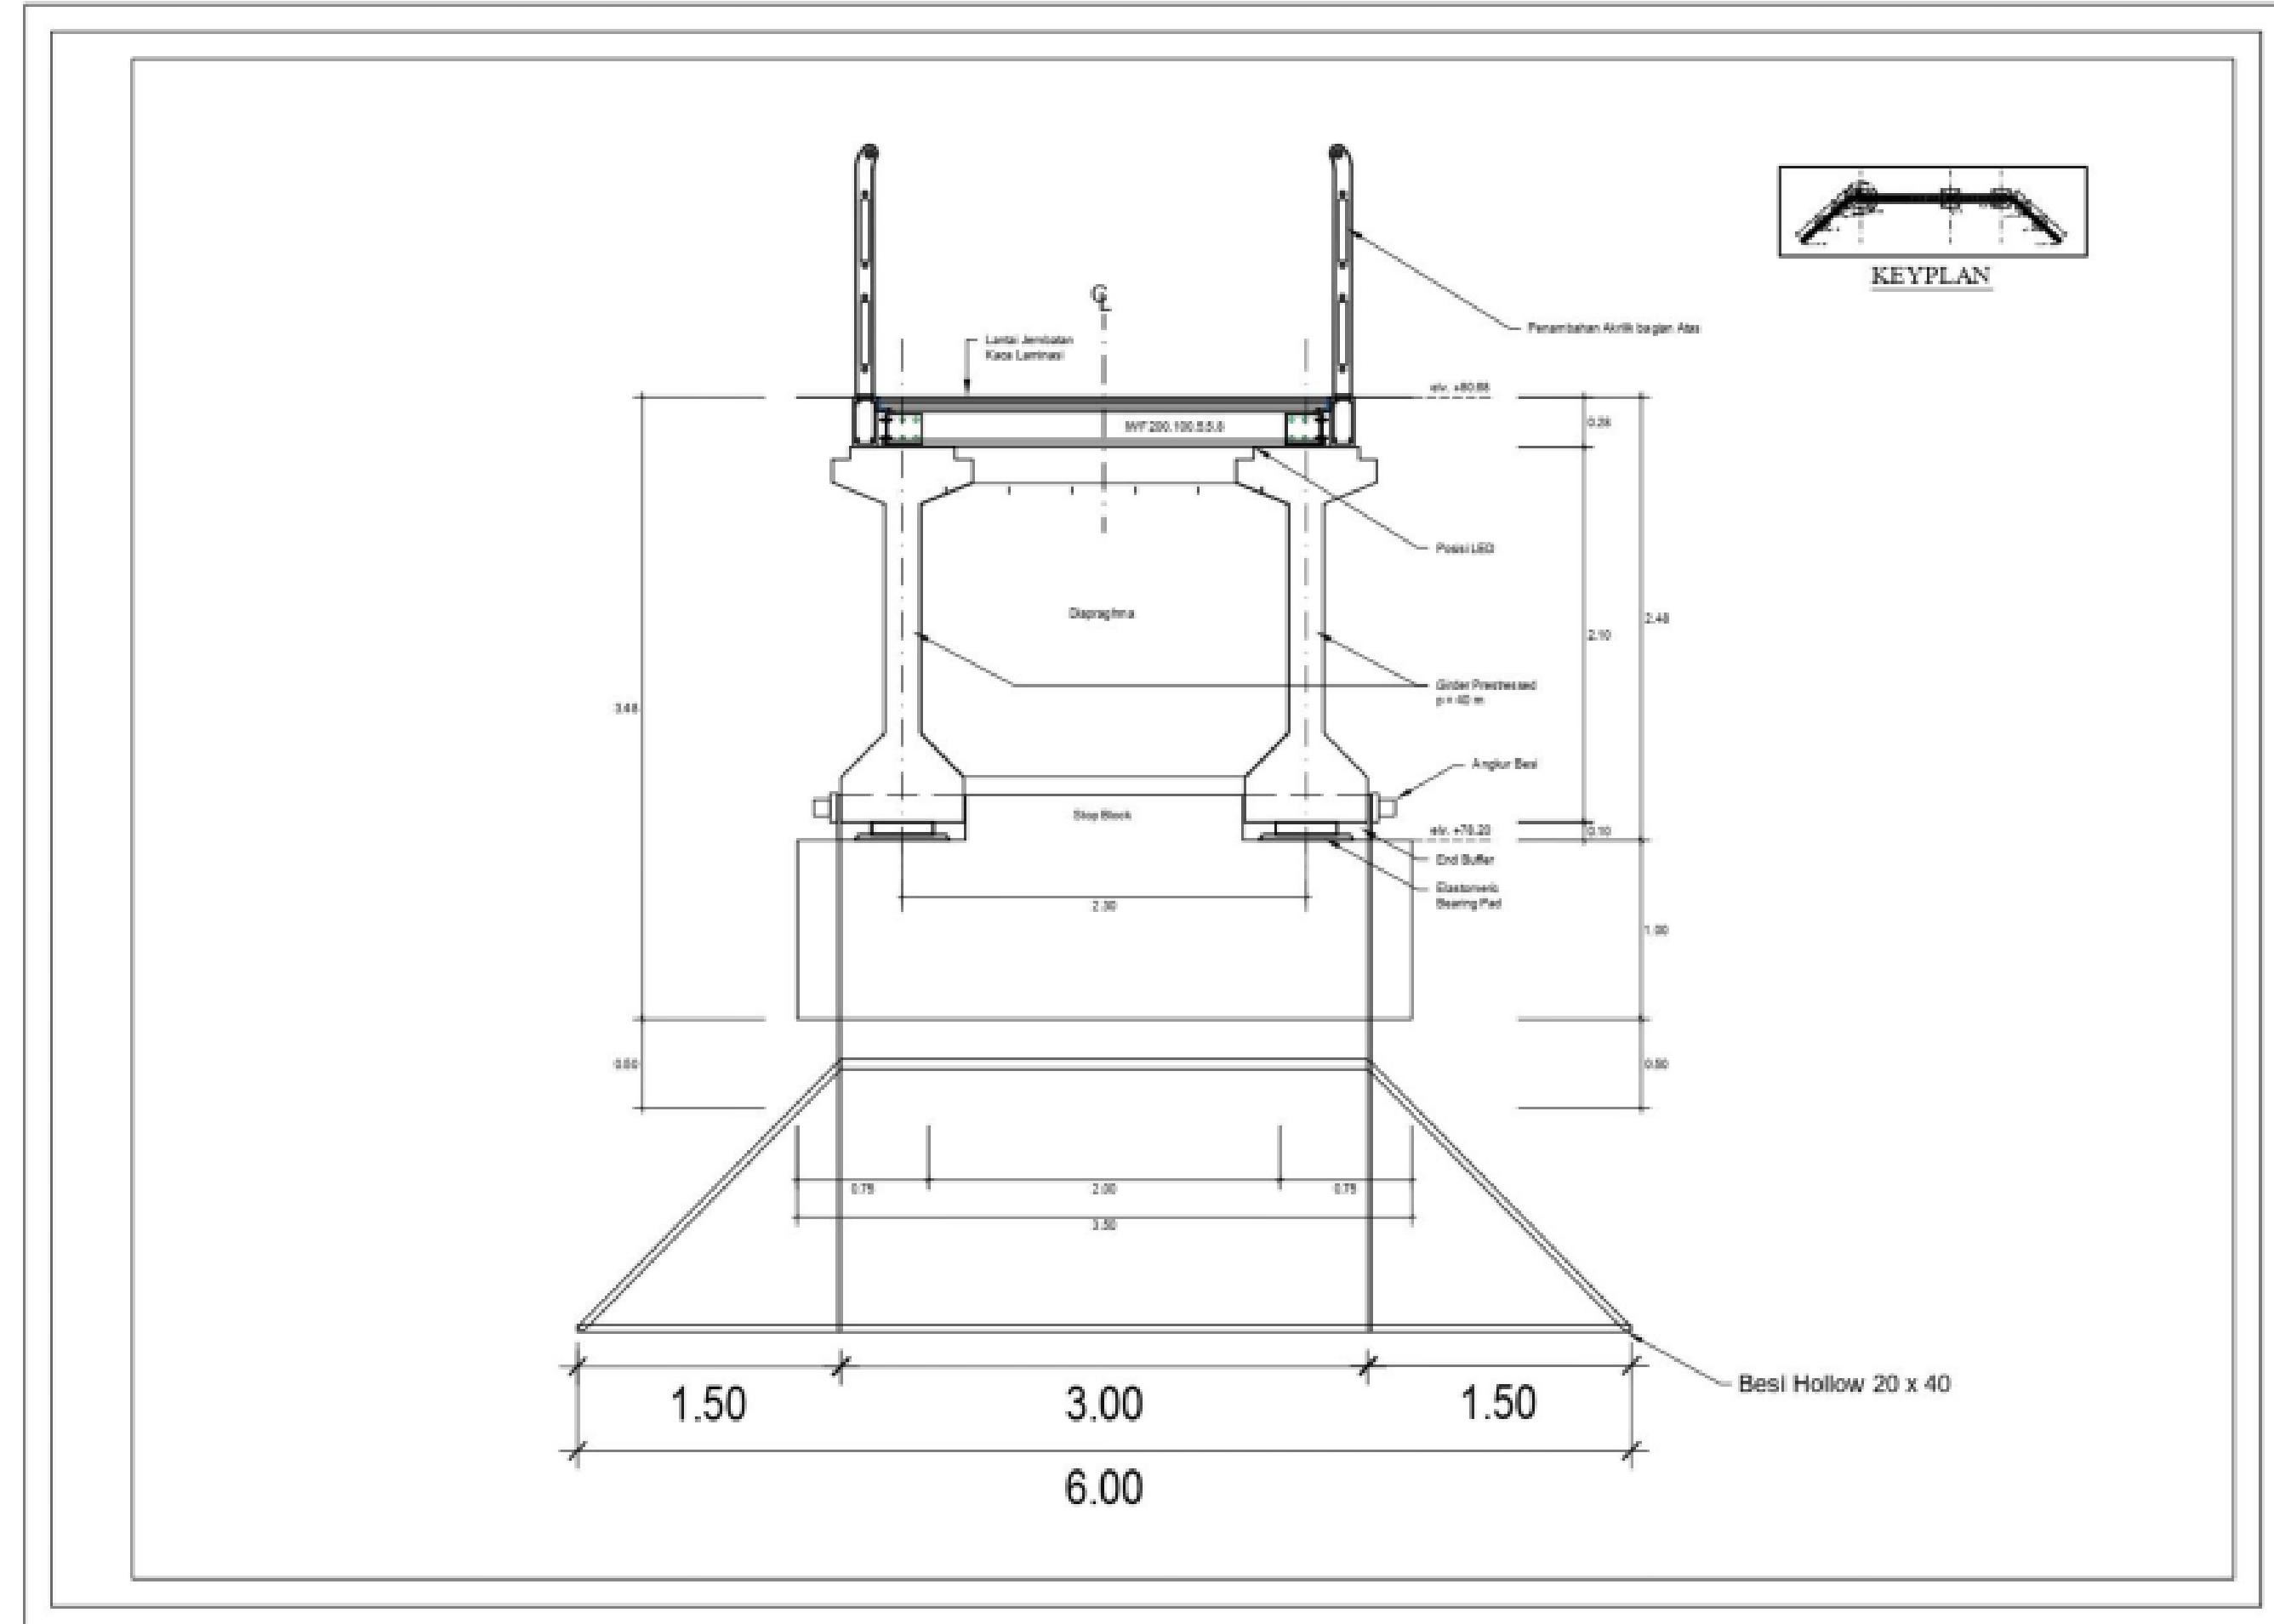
DED Detail Redesign Railing & Anak Tangga
